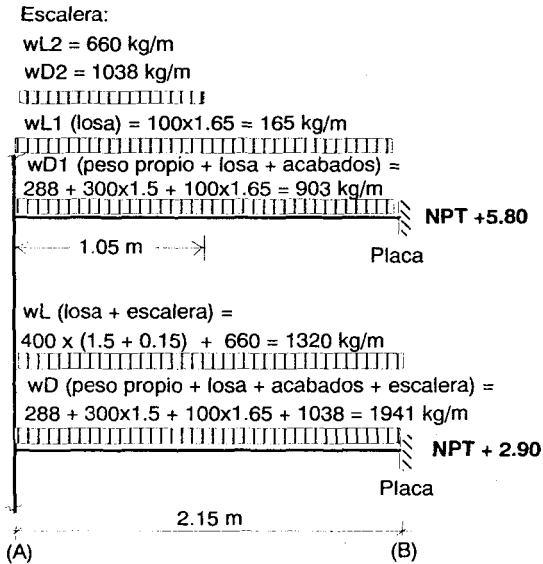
Cargas en las Vigas del Eje 2. Primer y Segundo Nivel.
